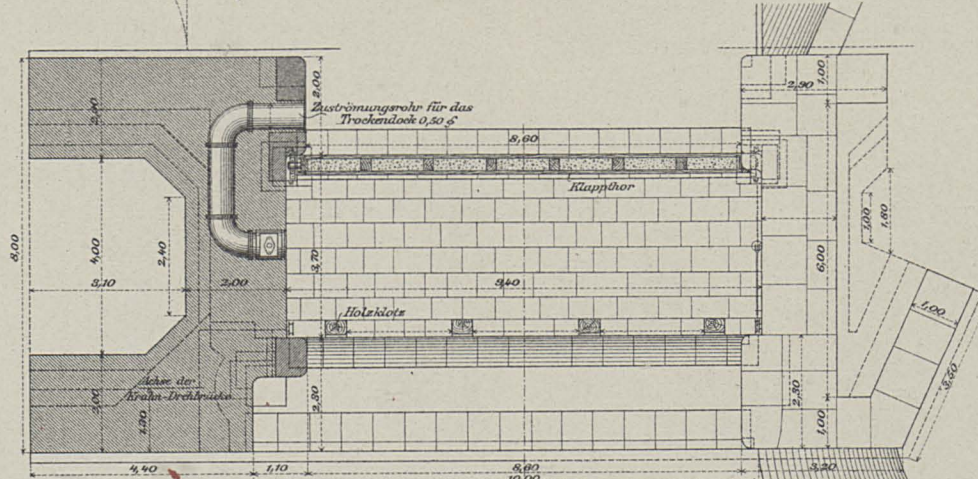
Grundriss des Hauptes. 1: 150.
